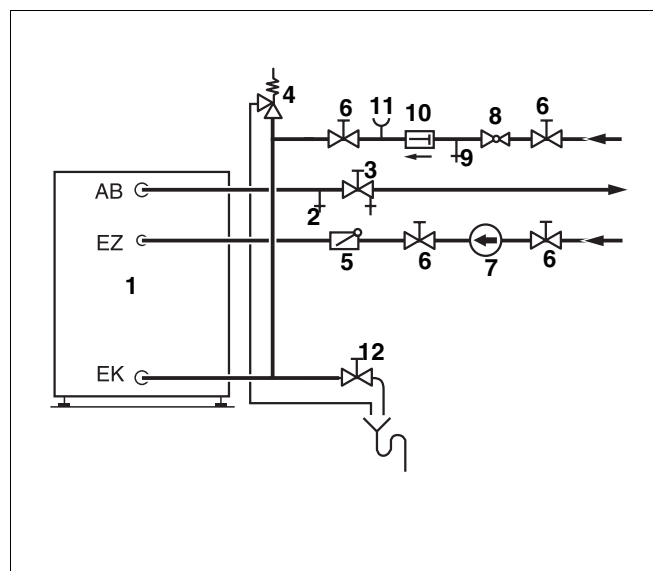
Installation und Ausrüstung der Trinkwasserleitungen
